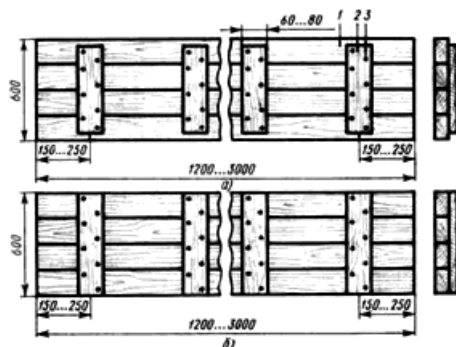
Щиты разборно-переставной опалубки для фундаментов
